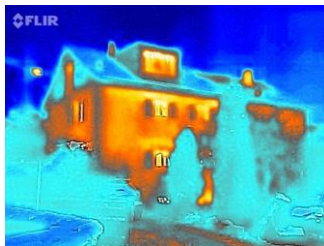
Aussenhülle und Dachaufbau nach Sanierung eines EFH's
